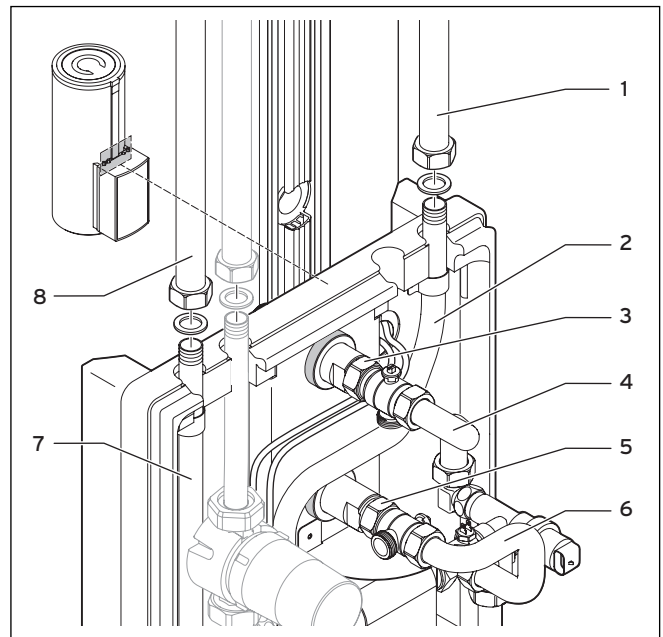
Anschlussverrohrung - hydraulische Montage an die Hausinstallation
